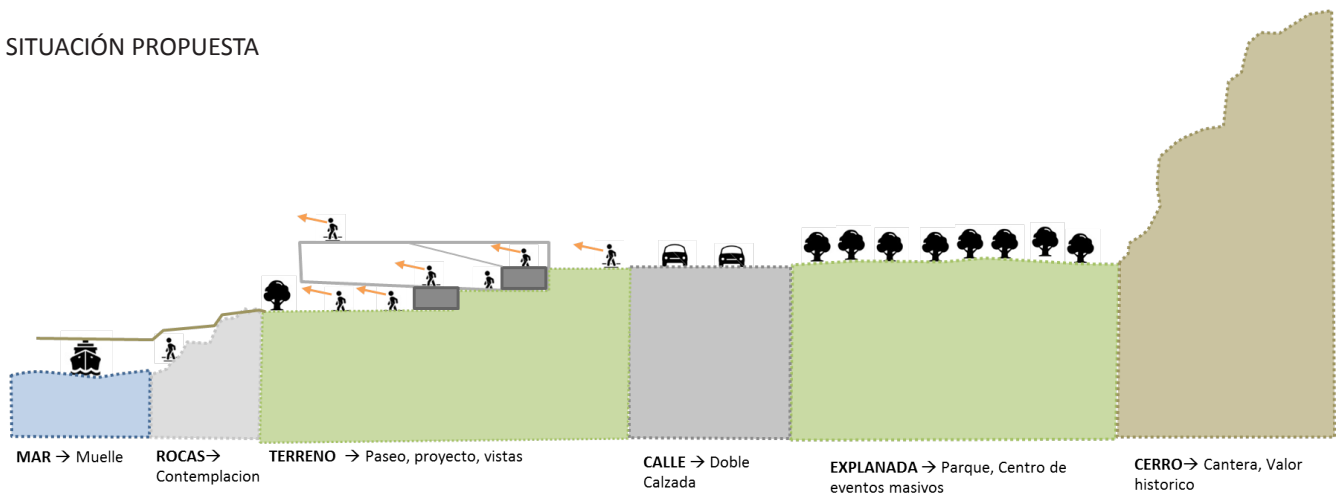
Corte Esquemático Situación propuesta, elaboración Propia.
